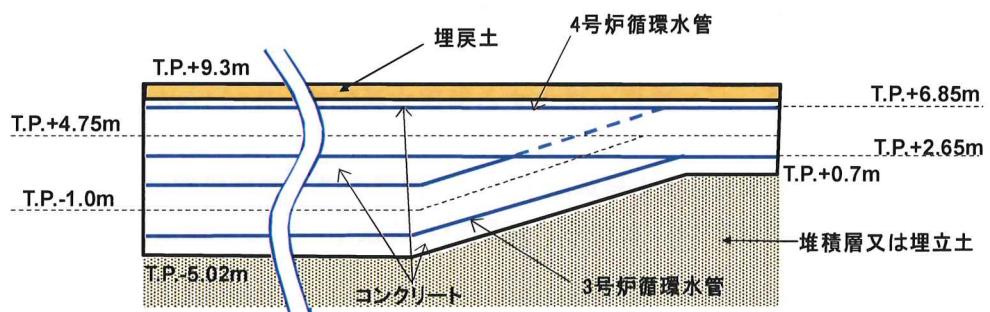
3, 4号炉循環水管埋設部②断面図
